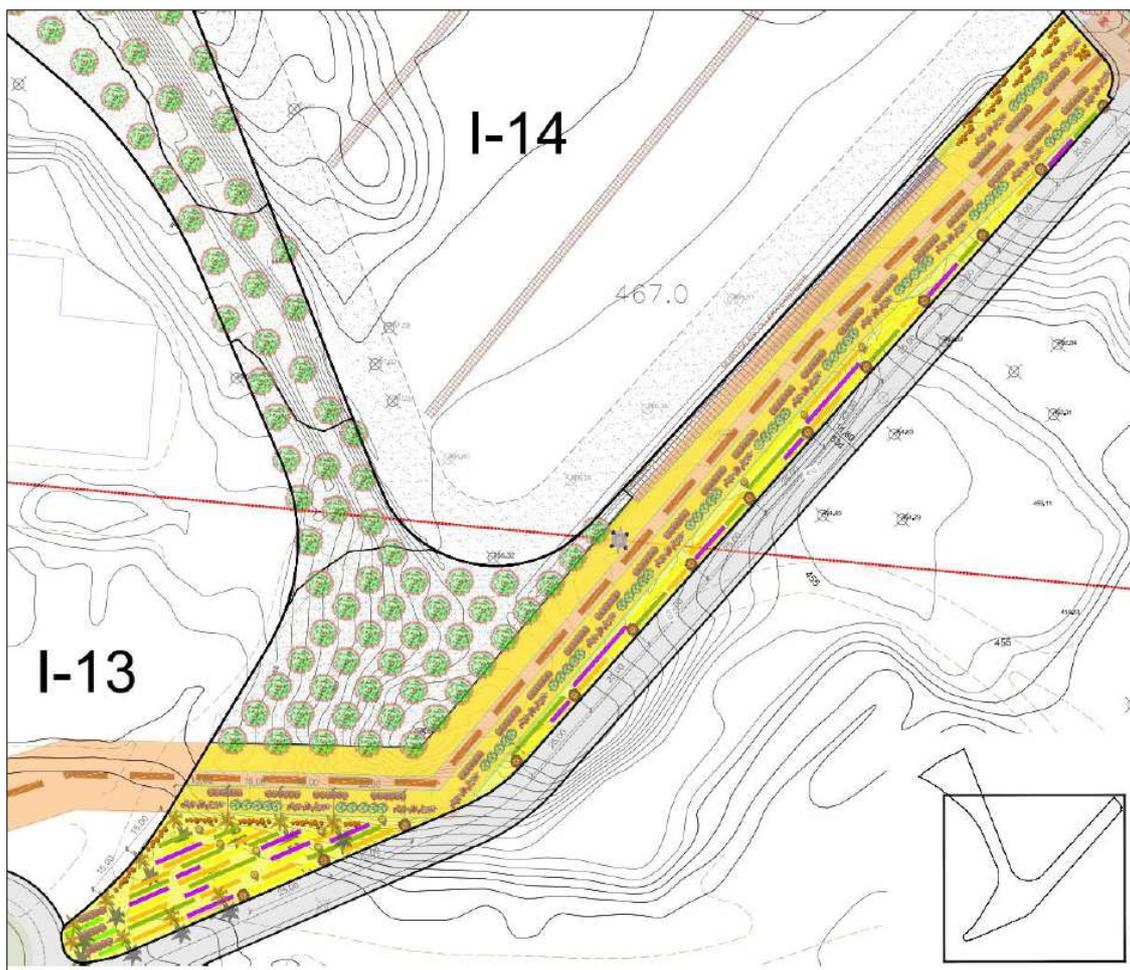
Proyecto en el ámbito de la DC-01 ZONA NOBLE.
